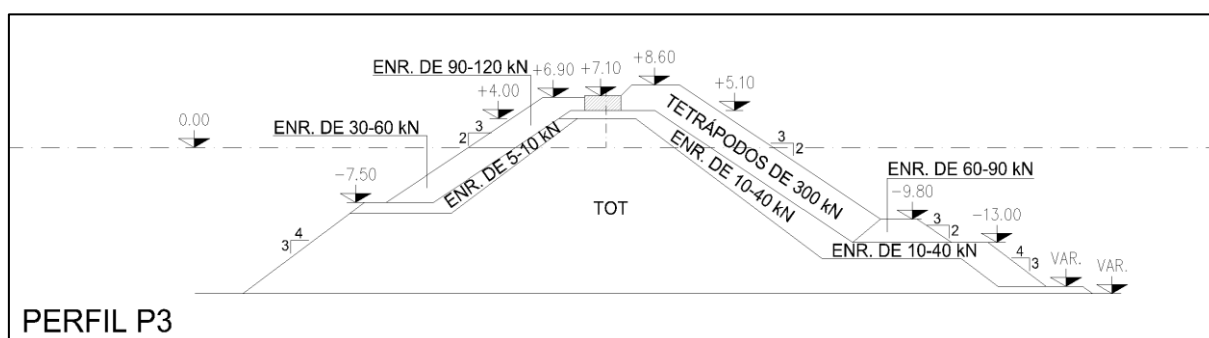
Perfil Transversal Tipo P3, construído em 1985
